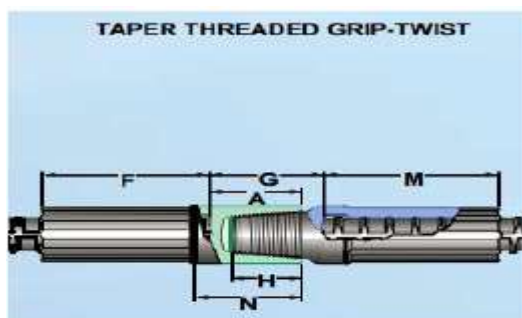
Dimensionamiento del conector mecánico Taper Threaded Grip Twist
